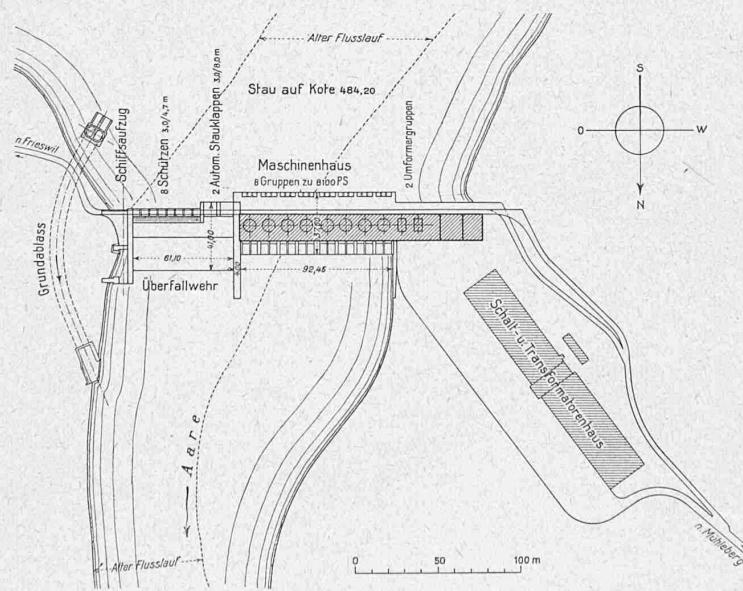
Lageplan des Kraftwerks Mühleberg. — Massstab 1:4000.
